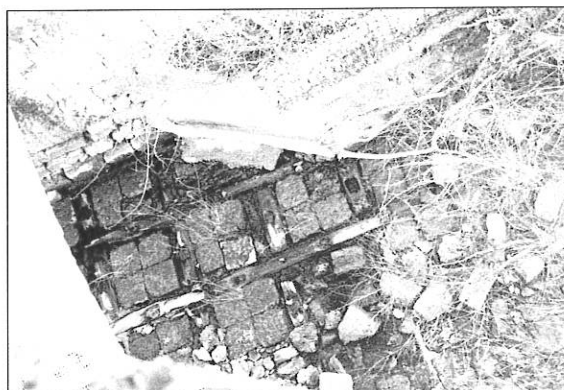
Cimentaciones originales del puente de San Martín de Rubiales, del siglo XVIII. Puede observarse el emparrillado de maderos que rigidiza la cimentación entre dos pilas consecutivas.
